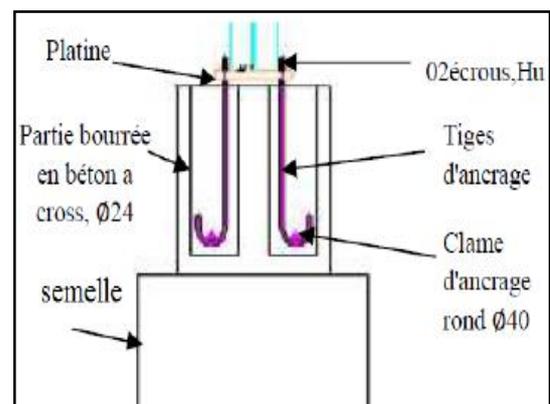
Détail n°: Articulation pied de poteau-fondation
